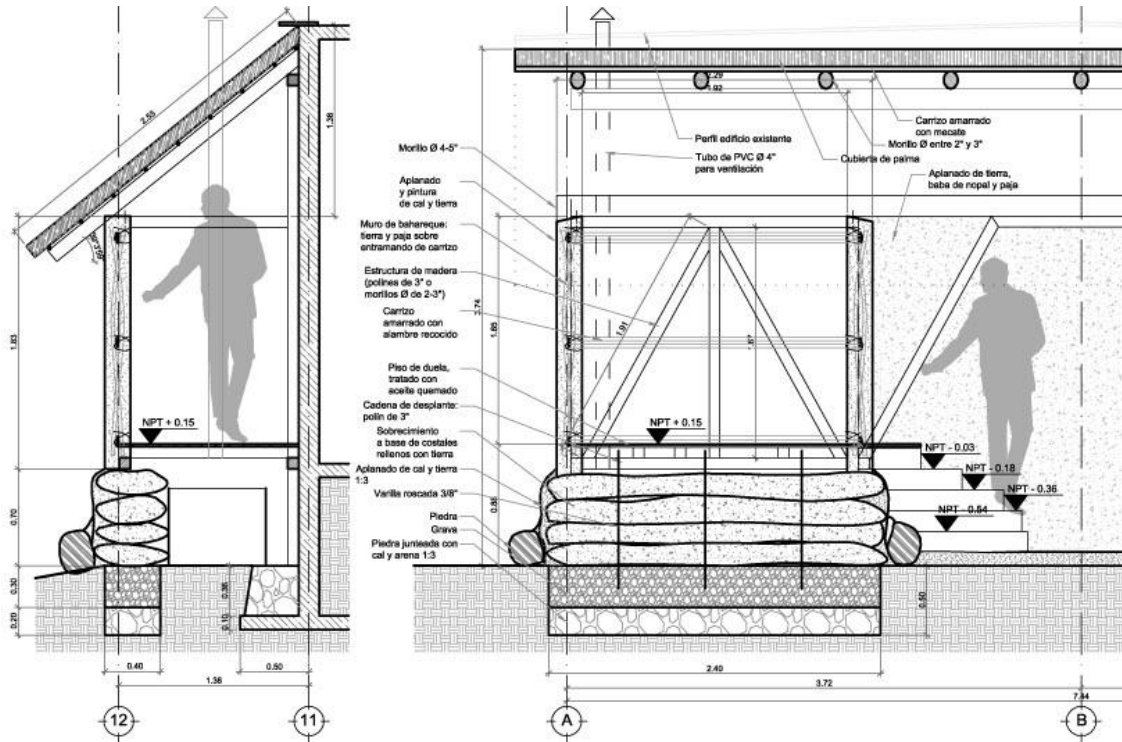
Plano 08; detalle constructivo del baño ecológico.
